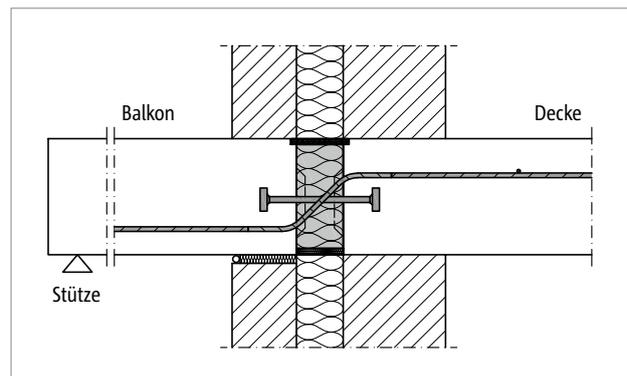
Schöck Isokorb® T Typ Q-P: Anschluss gestützter Balkon bei zweisechaligem Mauerwerk mit Kerndämmung
